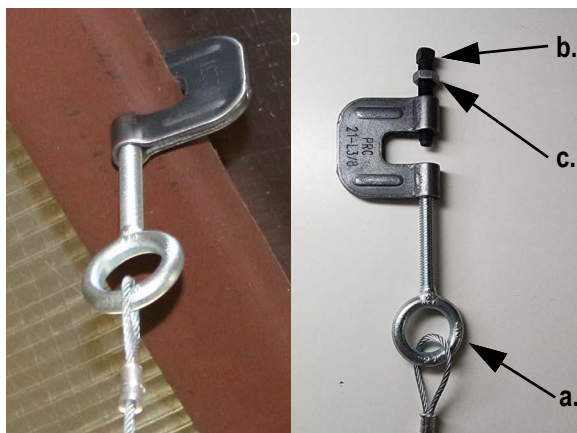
Morsetto della trave per fissaggio alla struttura del tetto
